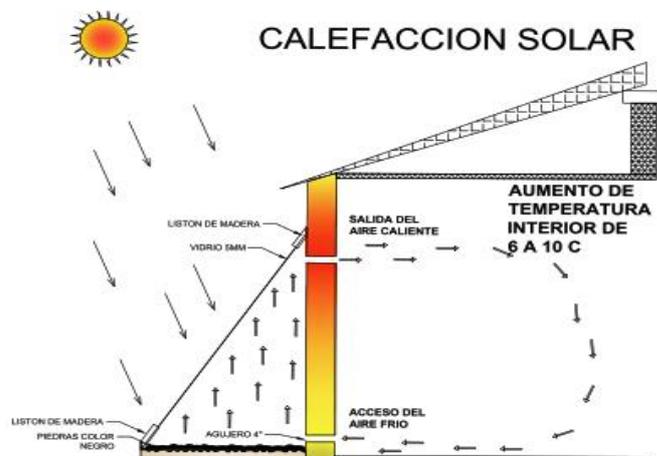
Detalle de calefacción solar pasiva muro trombe inclinado
